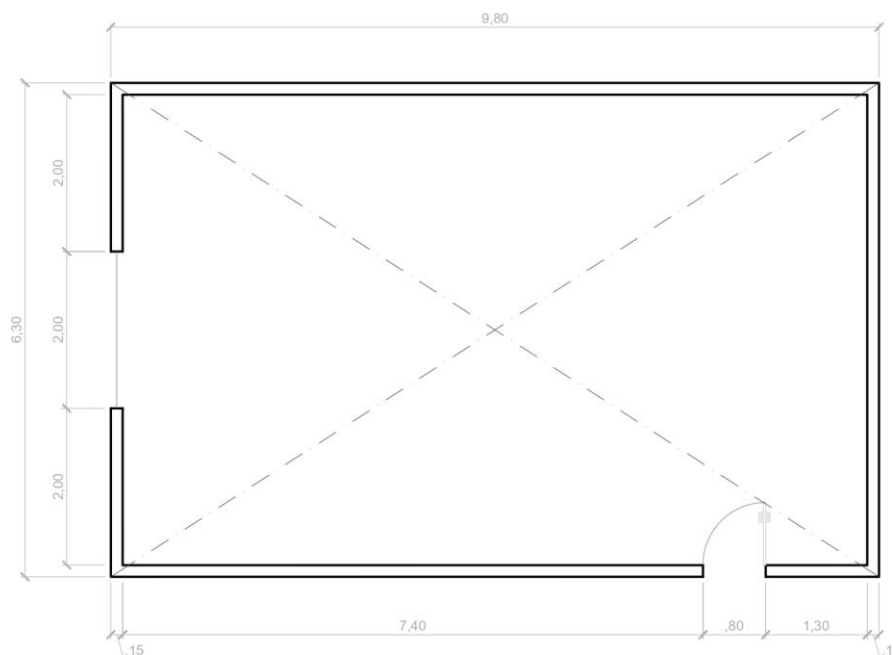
Esboço da planta baixa do galpão. (Autoria própria)
